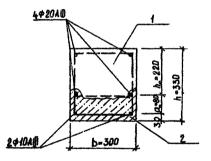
Сечение элемента, усиленного односторонним наращиванием.
